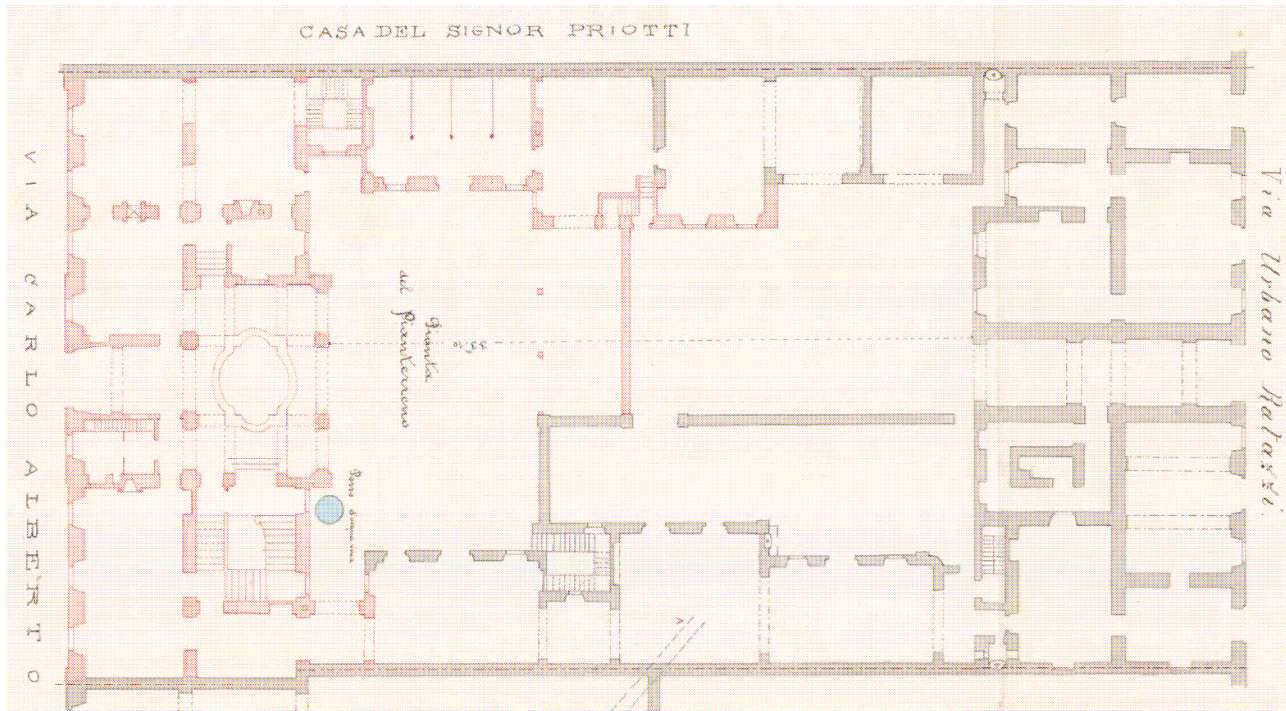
Antonio Debernardi - Pianta di Palazzo Lanza, 1881
